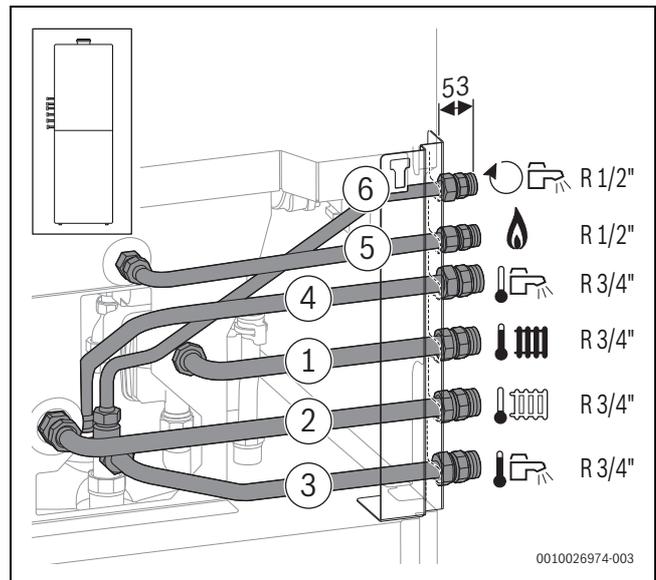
Vue côté arrière (dimensions en mm) : accessoire CS 10 monté sur le côté gauche
